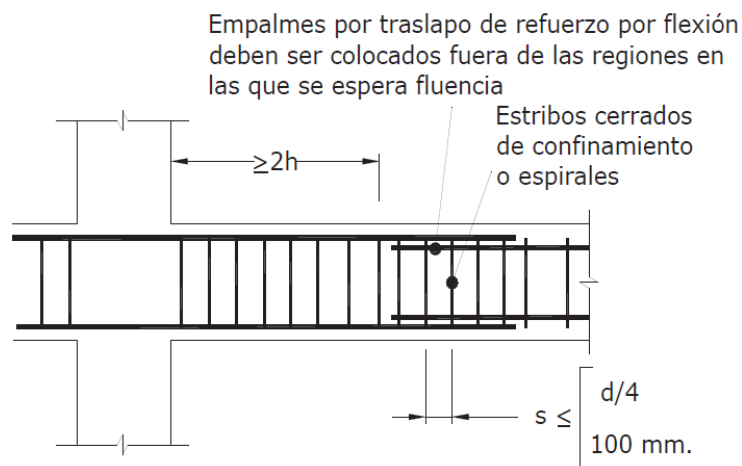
Confinamiento en traslape de varillas de refuerzo longitudinal.
